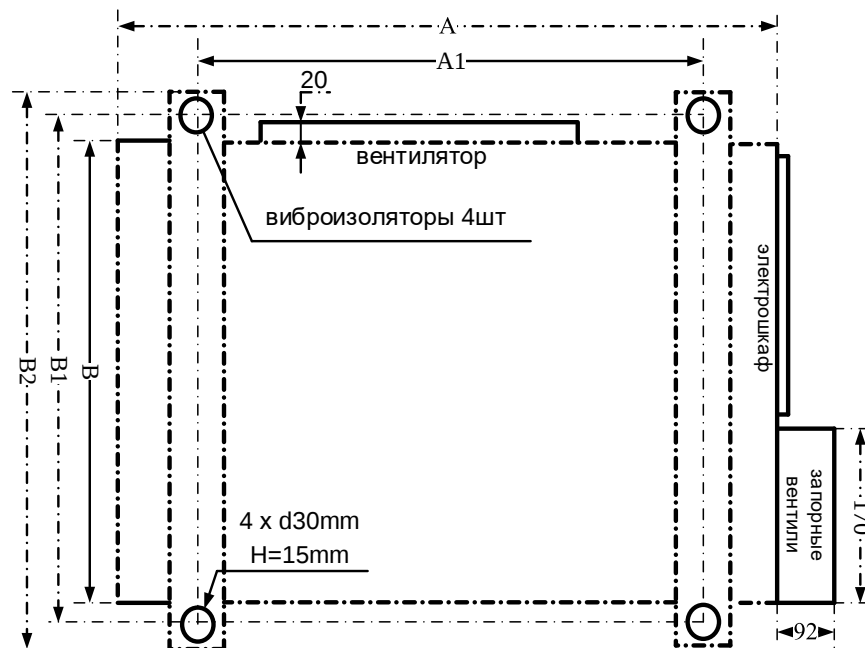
Схема габаритных размеров и крепления виброизоляторов к ККБ (вид снизу)
